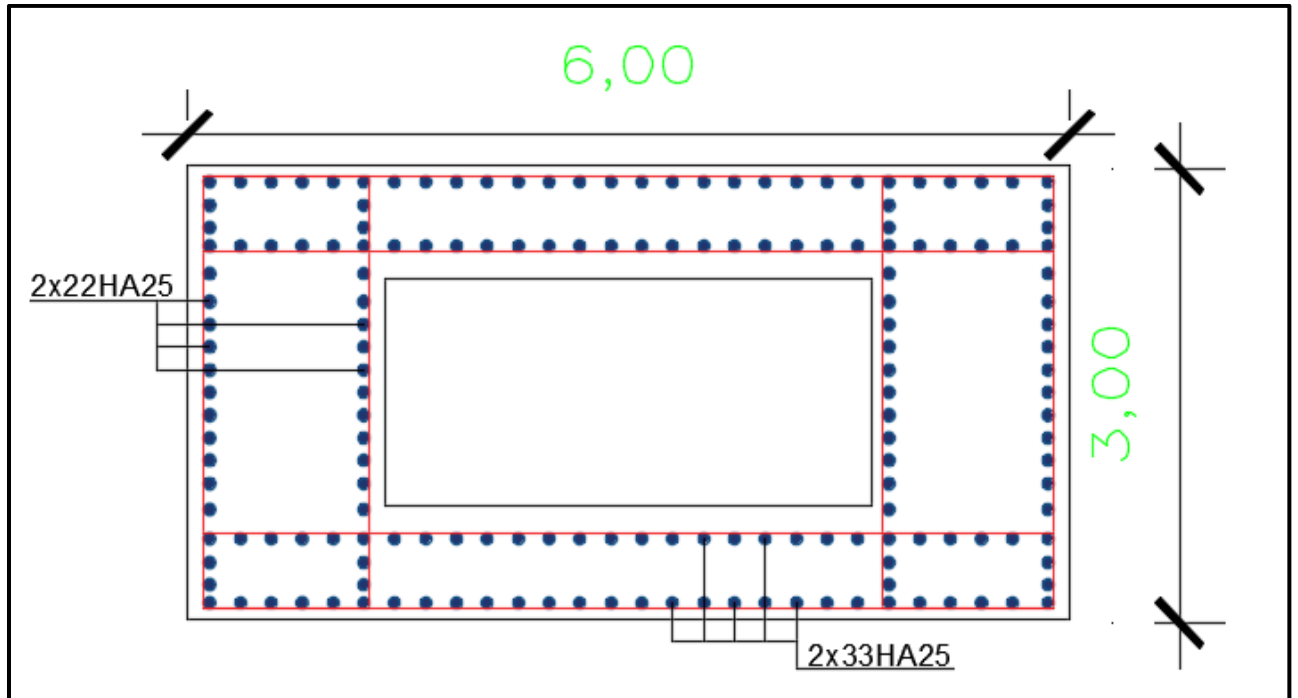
Ferrailage des piles 3-4-5 a la base
